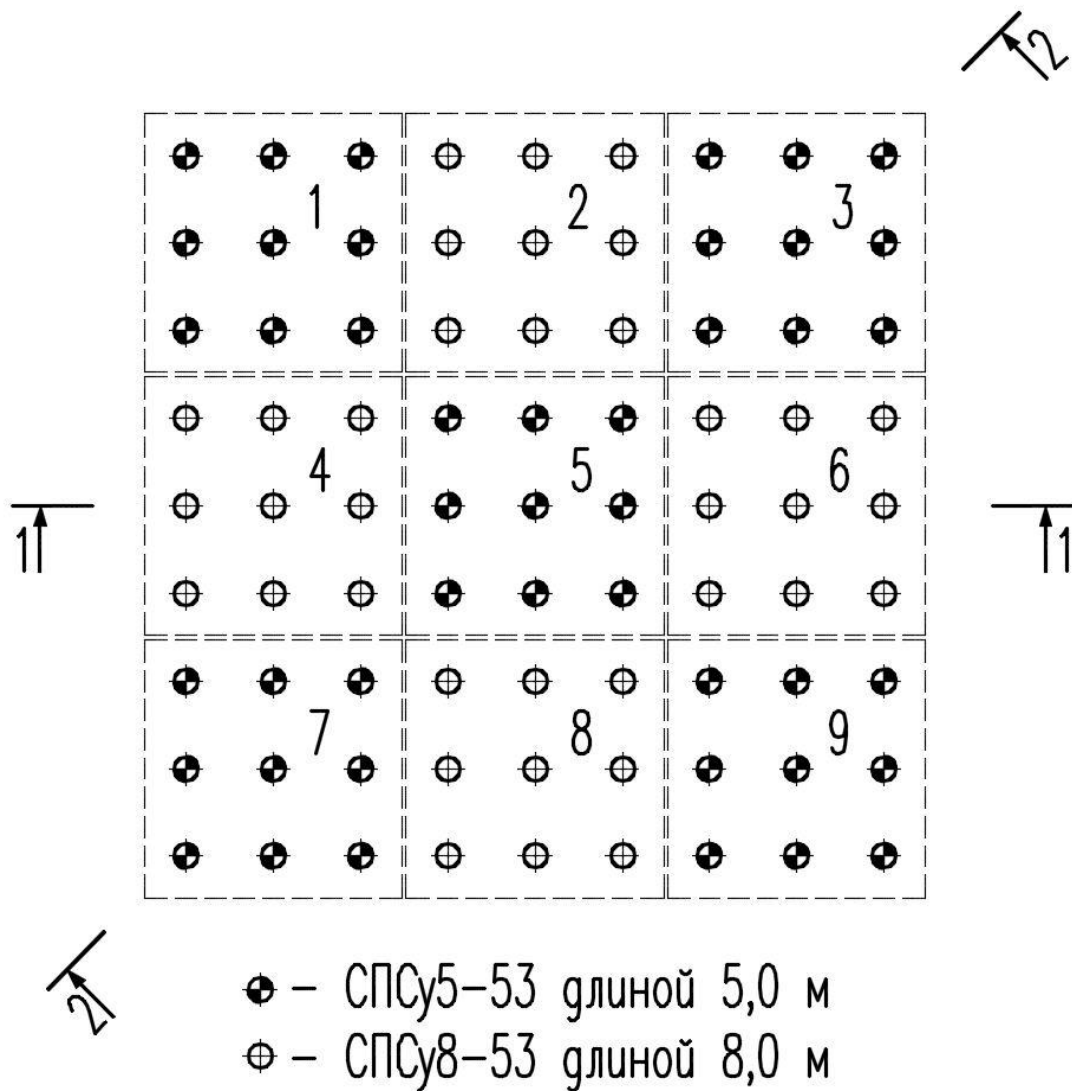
Фрагмент схемы кустов свай в плане
